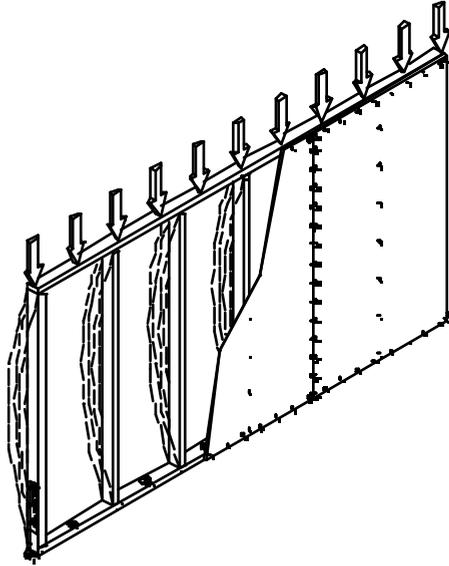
Parete Platform soggetta a carichi verticali. La resistenza è dovuta ai montanti verticali che si possono instabilizzare solo nel piano ortogonale alla parete, in quanto l'instabilizzazione nel piano della parete è impedita dal collegamento chiodato ai pannelli di rivestimento strutturale.
